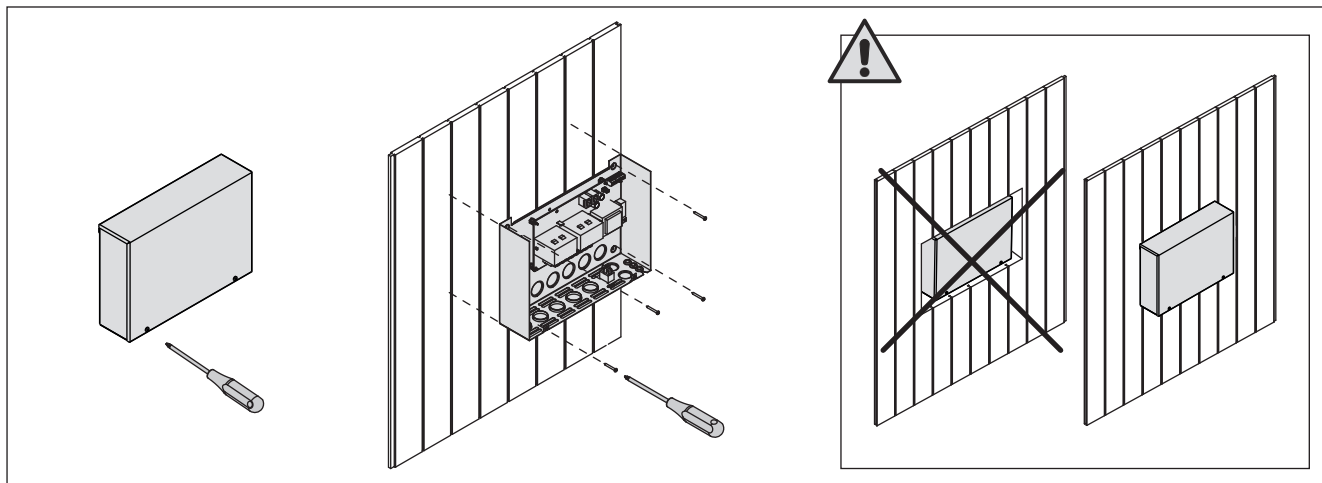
Снятие крышки блока питания и его крепление на стене
